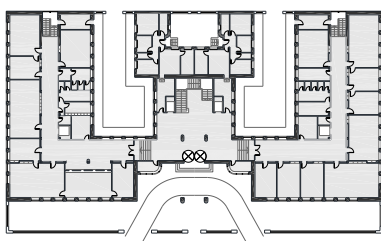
Planta calle del edificio original de los Borobio, Zaragoza, 1936.
